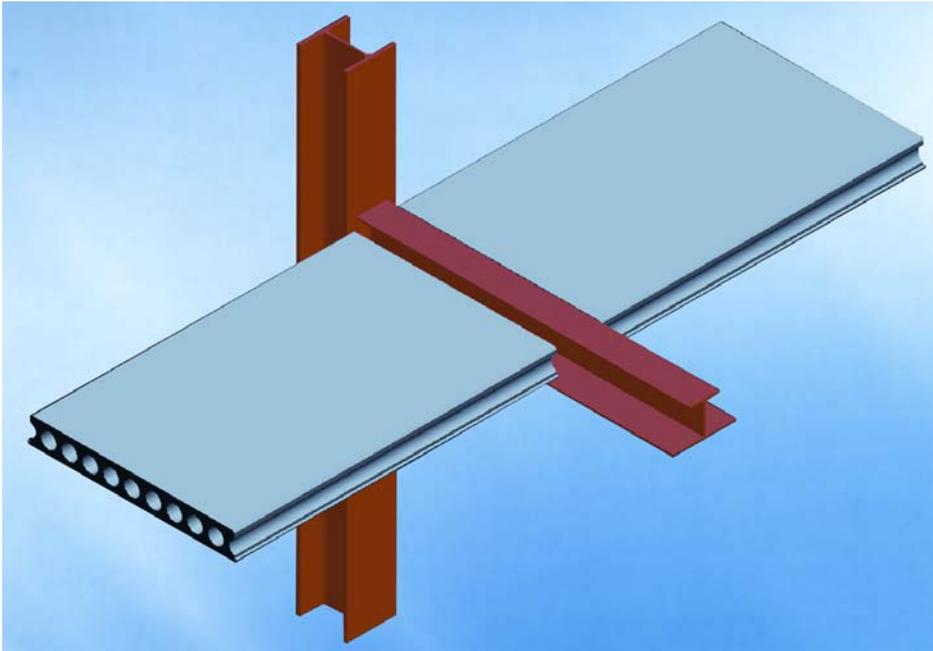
Poutres de plancher intégrées supportant des dalles préfabriquées en béton
